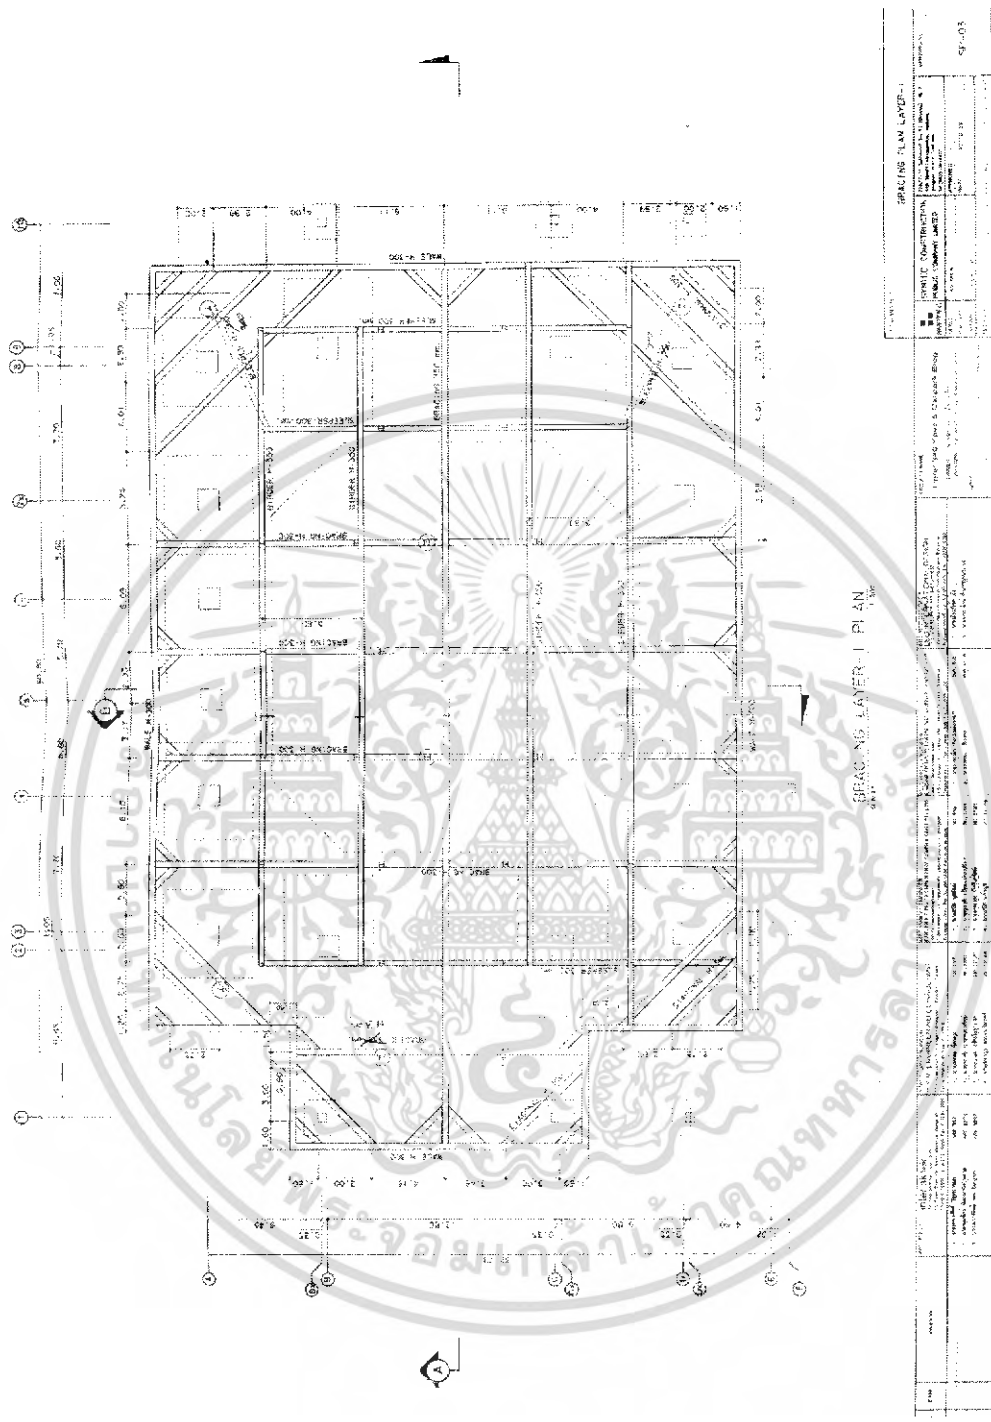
แสดงภาพแปลน sheet pile และ kingpost ของโครงการ The Charisma
